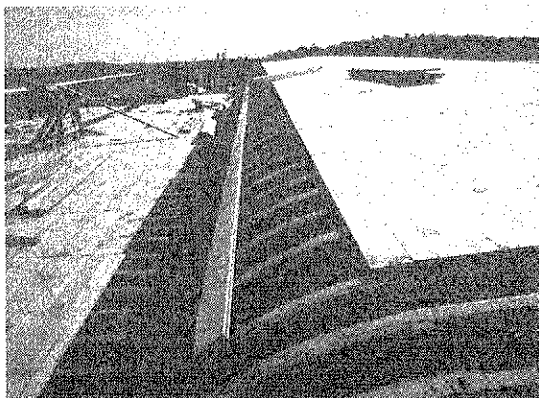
Detalles de cimbrado, encofrados y zonas de apoyo.
